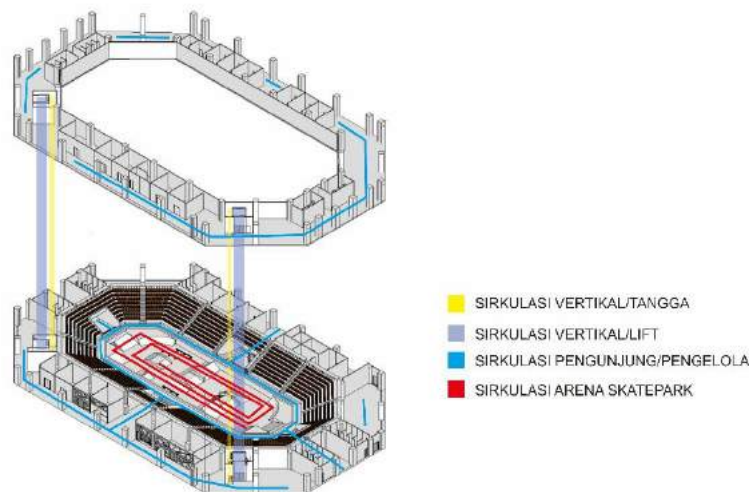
Konsep Interior Skatepark dan Wall Climbing
